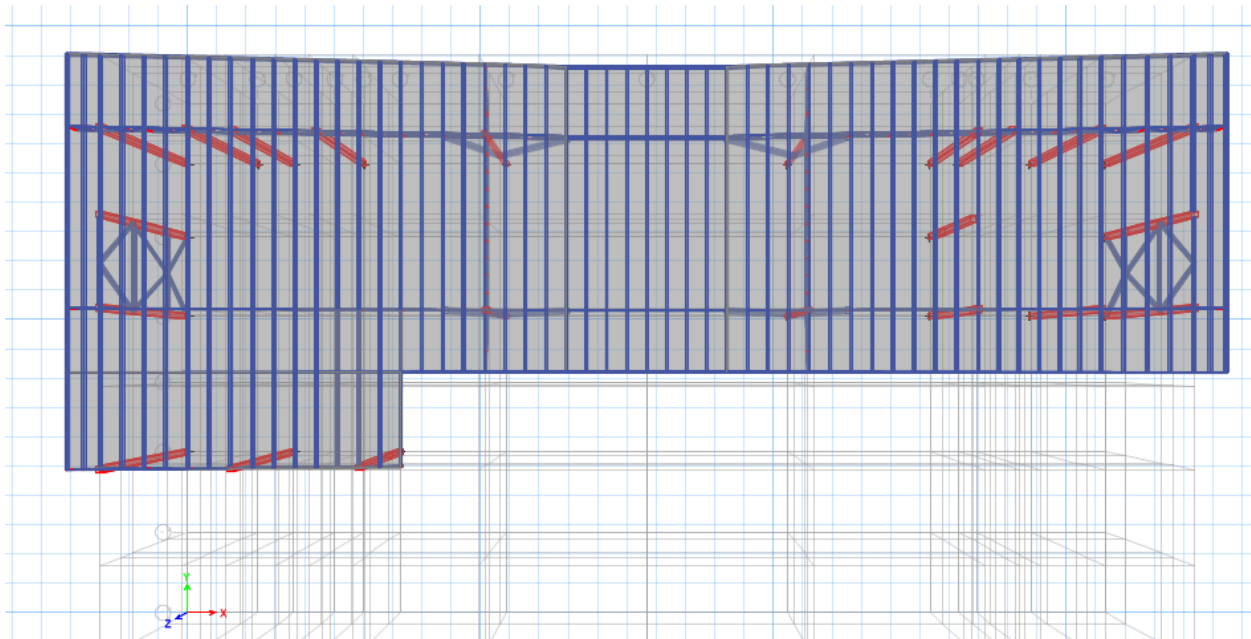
Planta 3D Estructura de armaduras.
